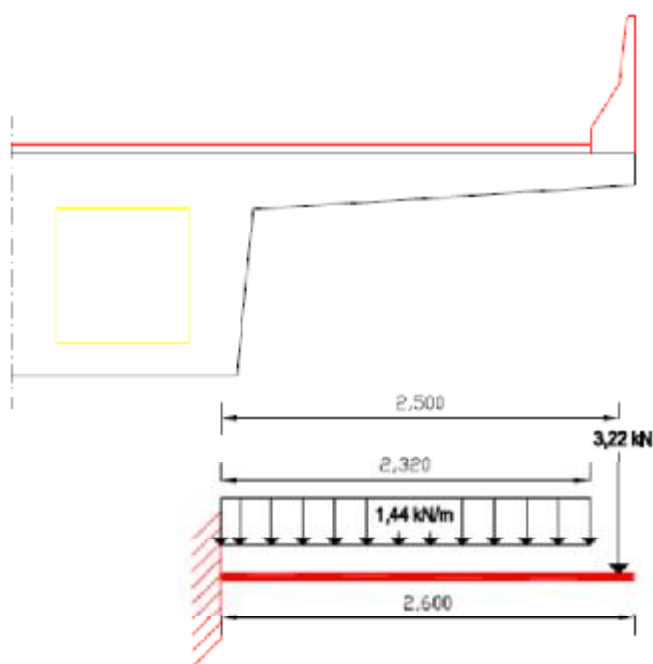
Carregamento das consolas devido às acções da Restante Carga Permanente
